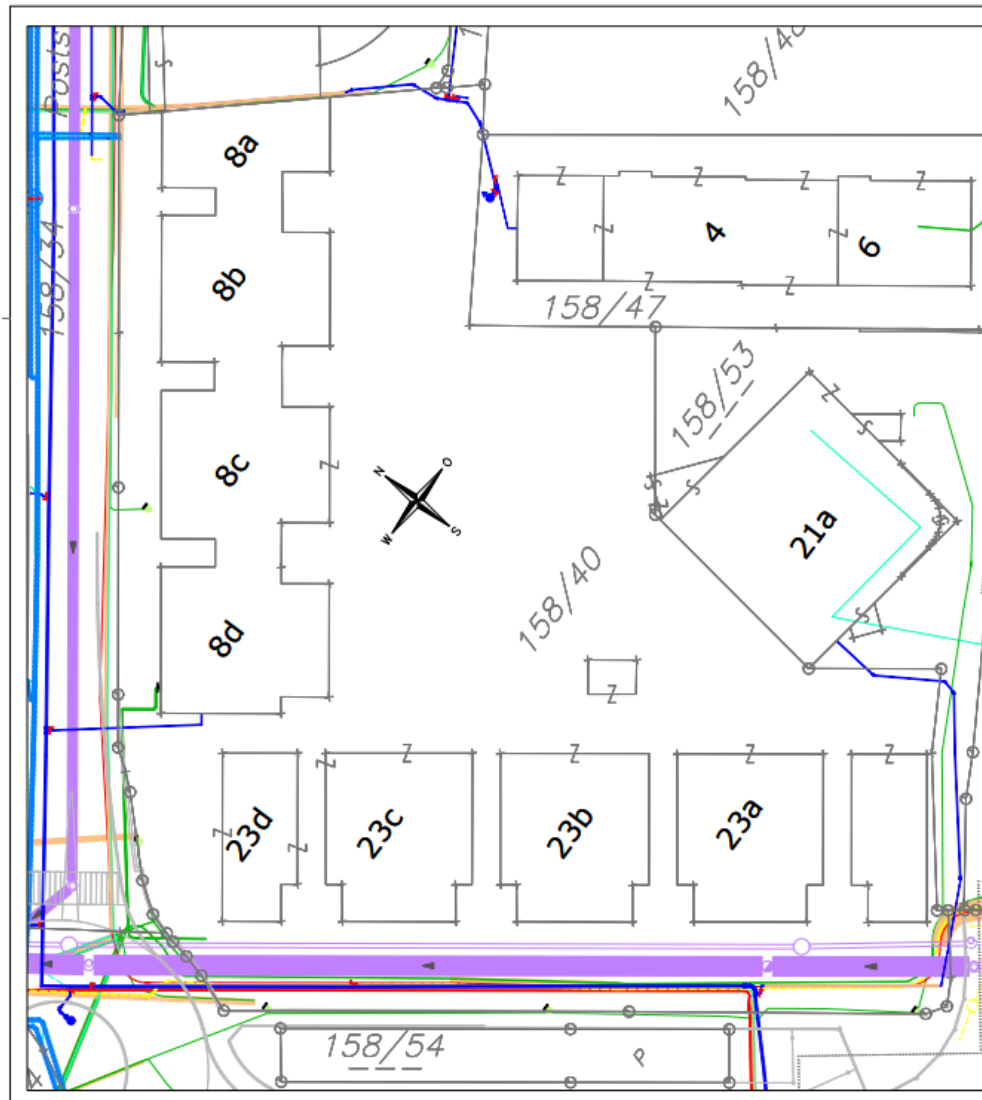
Lageplan Leitungstrasse Stadtwerke Wörgl (TZ 1475/1992; Seite 2/2)
